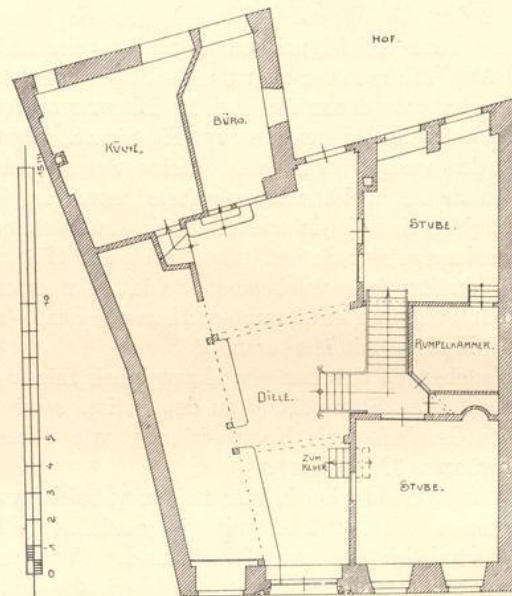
Osterstraße 1. Haus vom Hagen. Grundriß.
